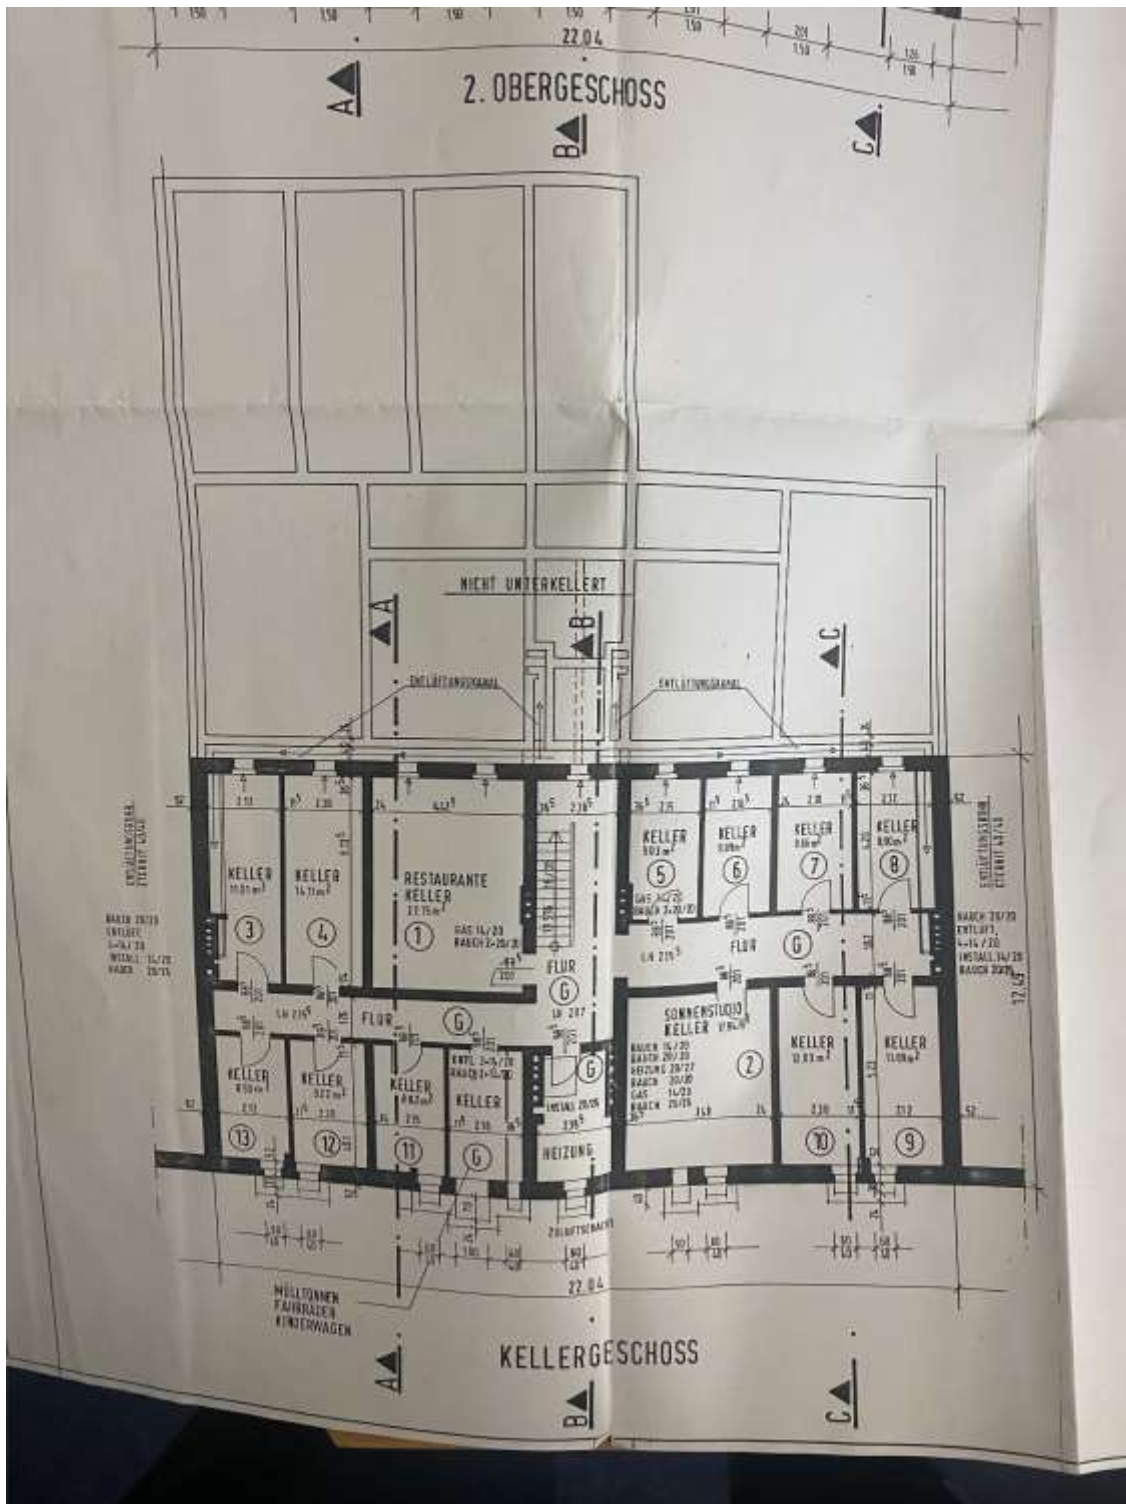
Kellergeschoss / Quelle: Aufteilungsplan Grundakte
